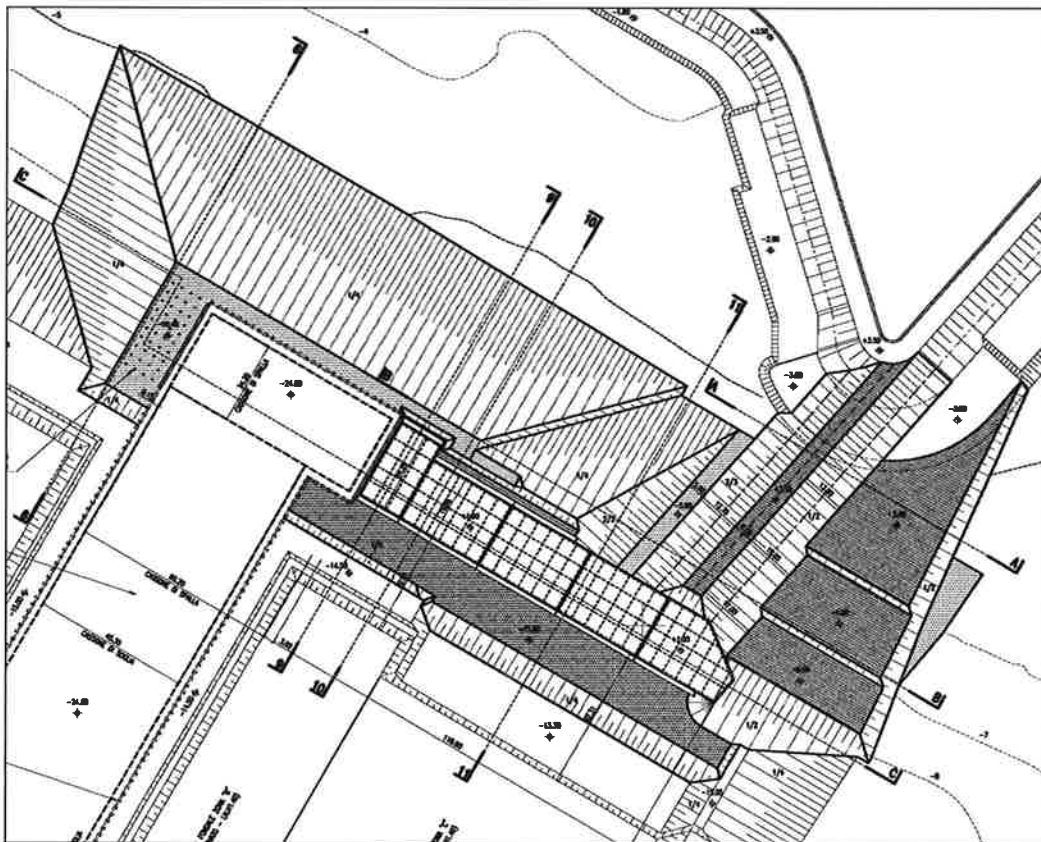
SPALLA NORD, PLANIMETRIA DELLE OPERE DELLA PRIMA WBE DELLA SPALLA NORD
